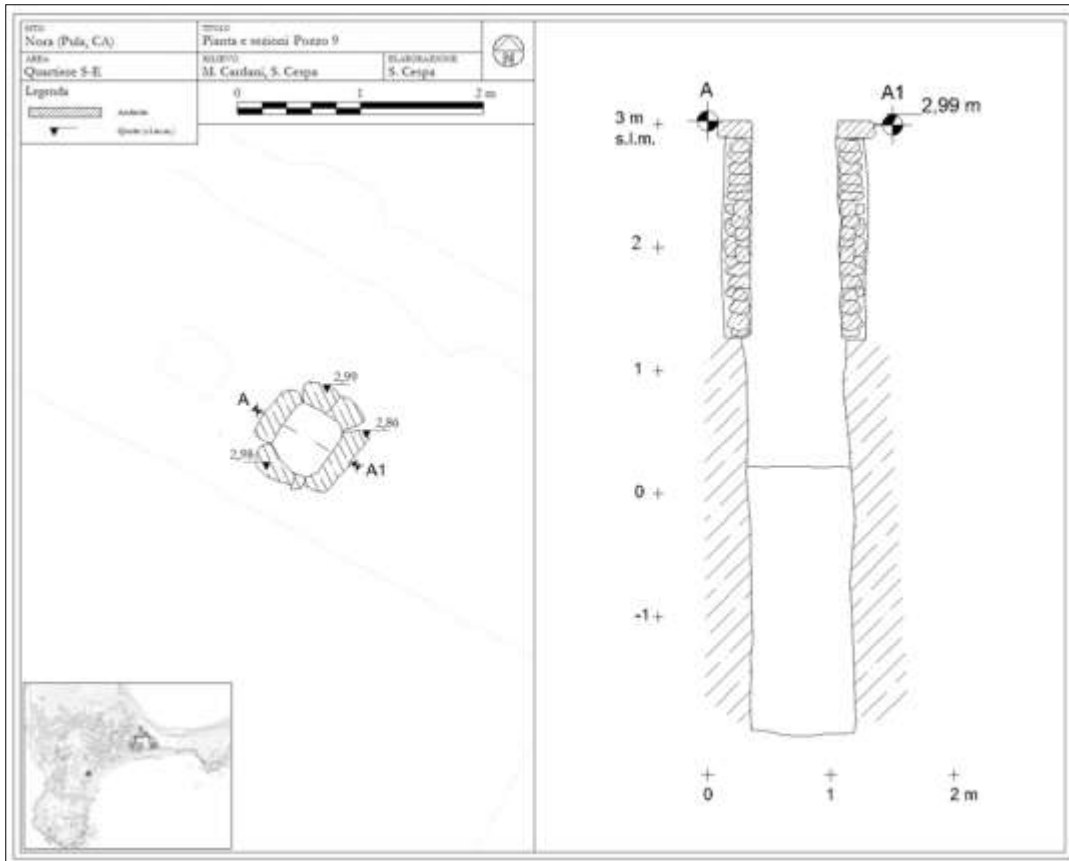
Pianta e sezione del pozzo 9 (elaborazione dell'autore).
